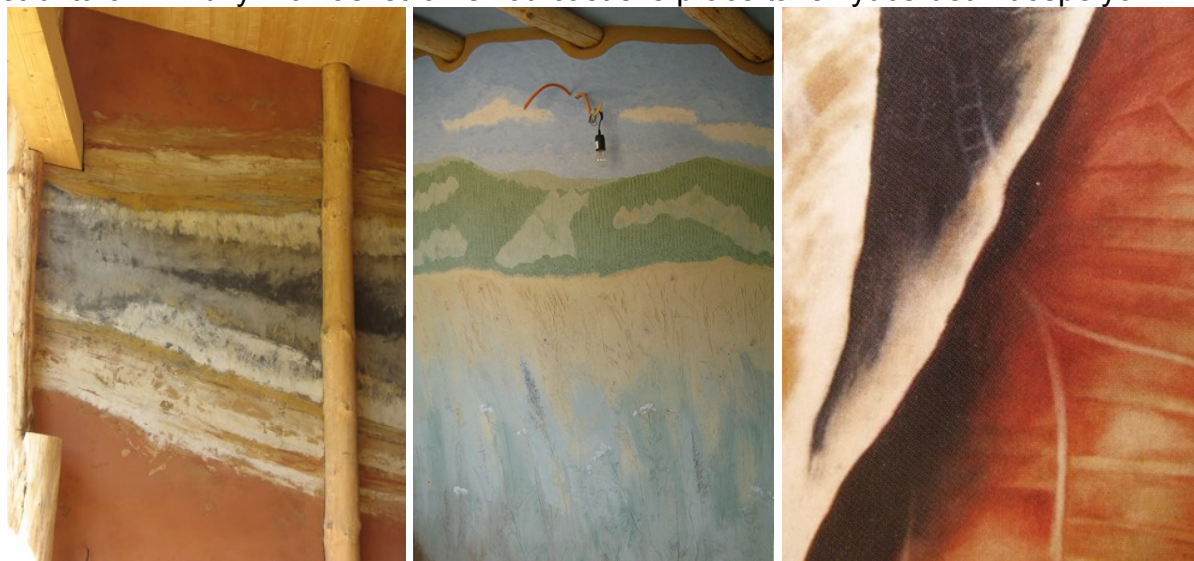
Kobylí, Obr.15 - Hradčany, Obr.16 - Výžerky
